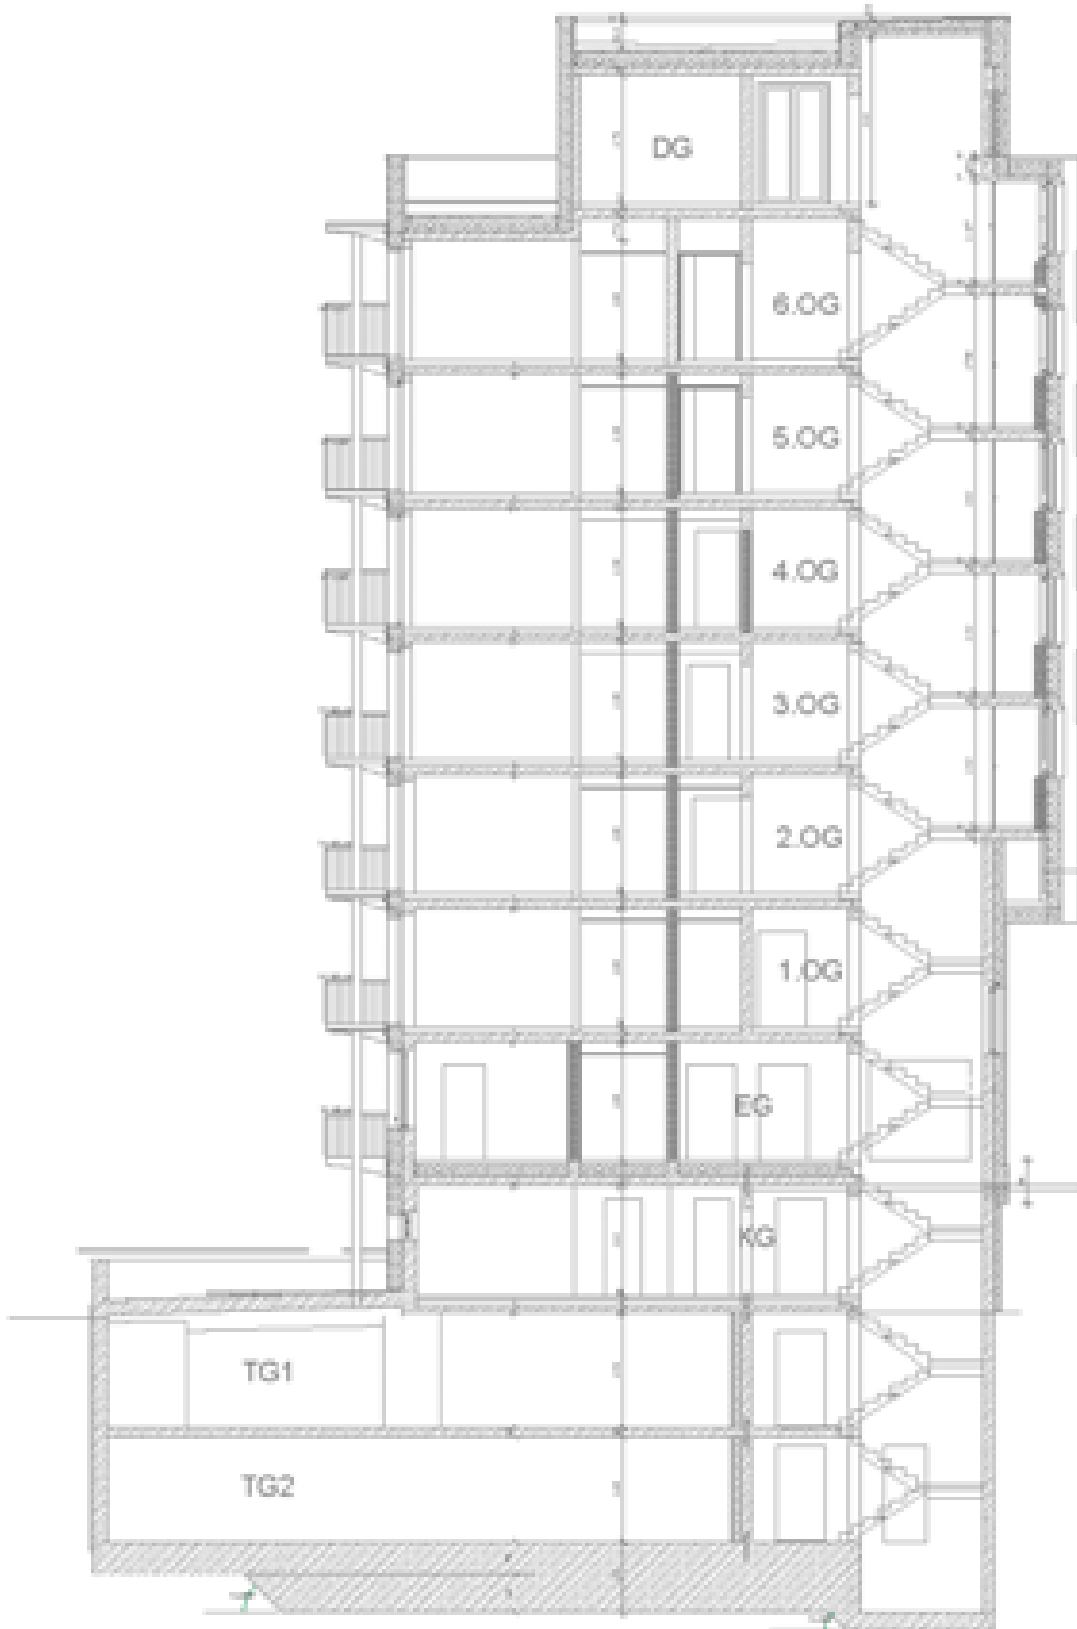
Gebäudeschnitt in der Ebene des Treppenhauses (Quelle: Plan -R-).
